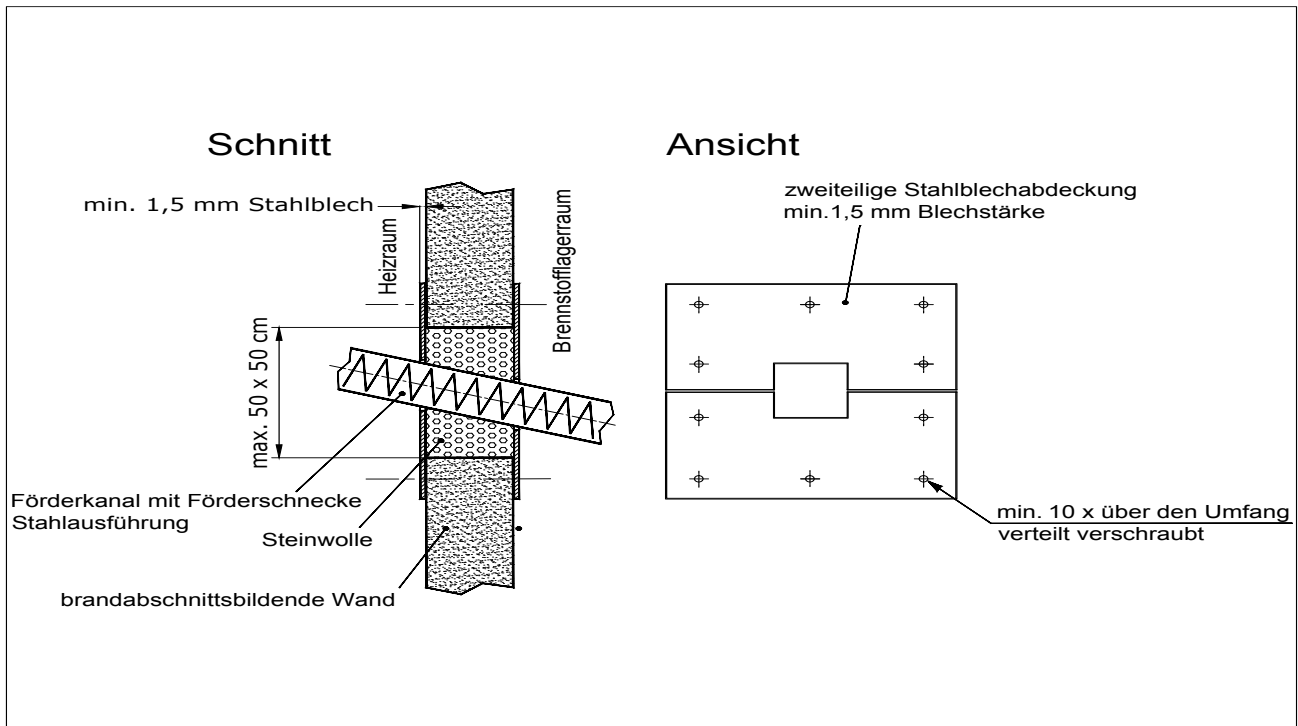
Ausführungsbeispiel einer Förderkanaldurchführung durch eine brandabschnittsbildende Wand zwischen z.B. Heizraum und Brennstofflagerraum.
